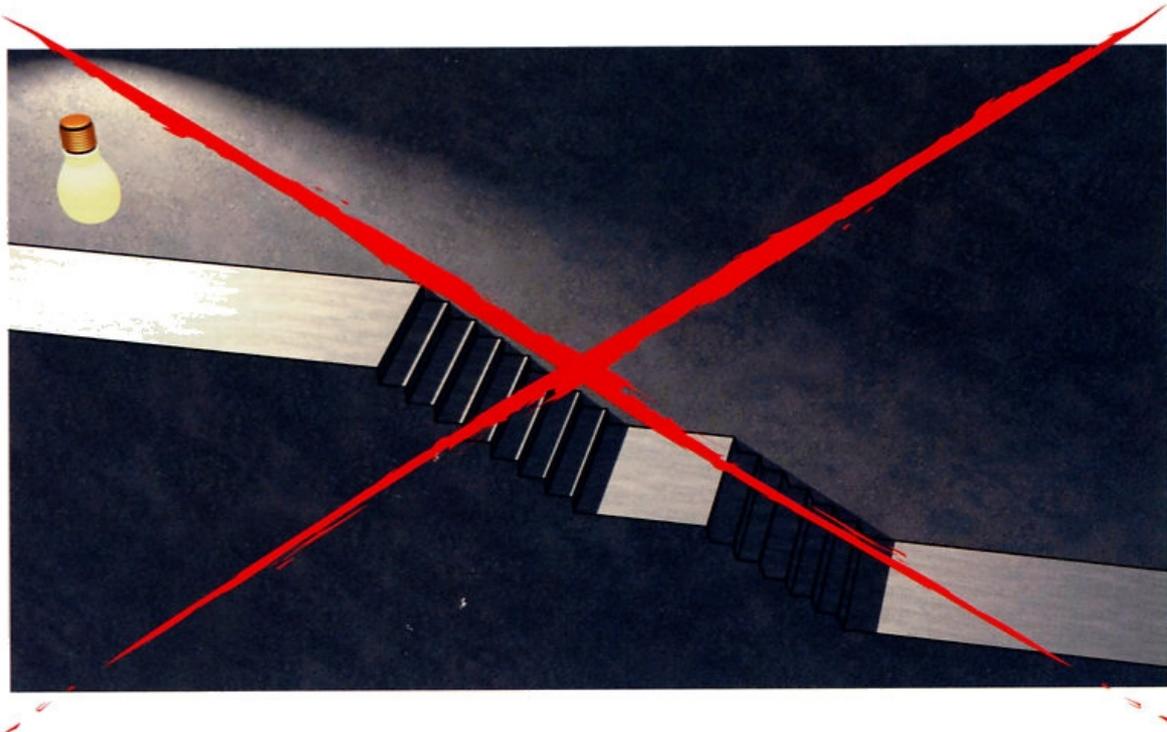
Forme d'éclairage interdite d'un escalier.
